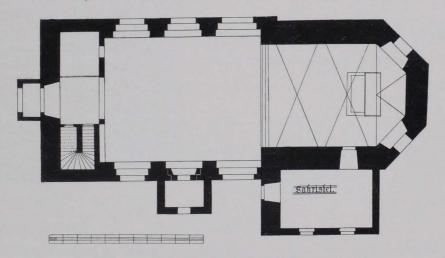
Buchbach, Pfarrkirche, Grundriß 1:250 (S. 116)
